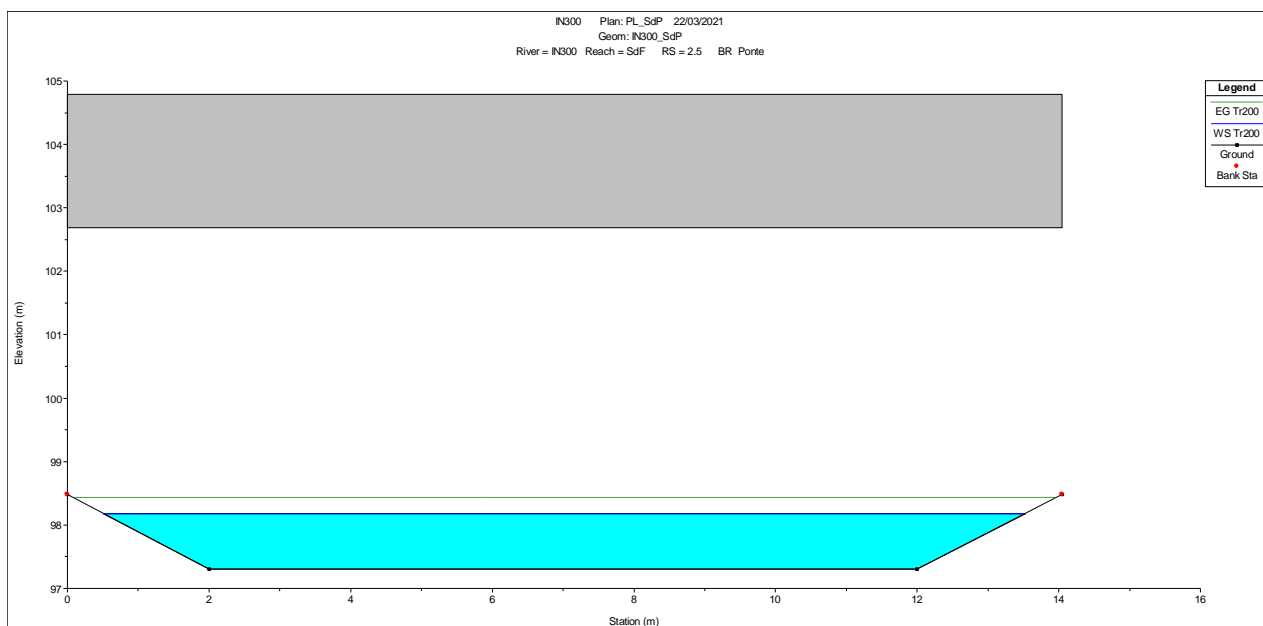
Sezione valle manufatto – stato di progetto interferenza IN300.
